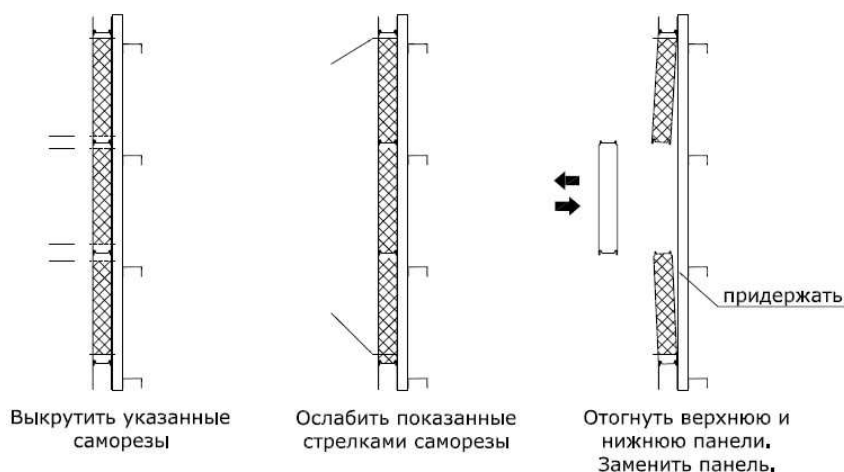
Демонтаж повреждённой стеновой панели
